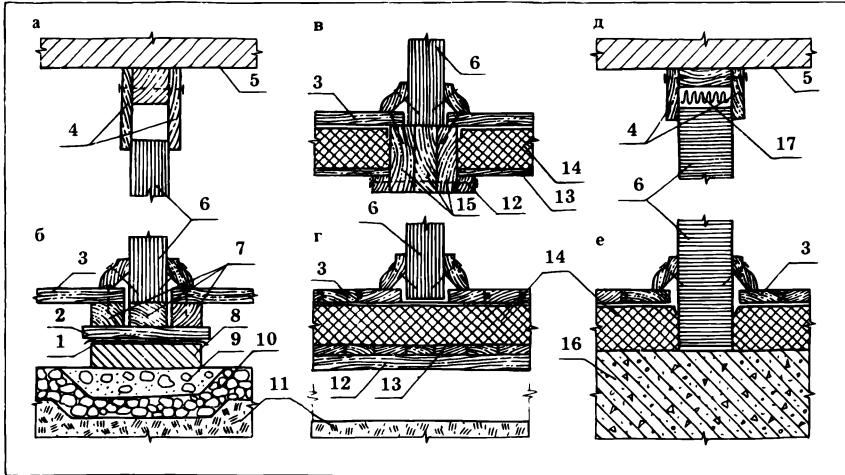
Примыкание перегородок к опорам и перекрытиям
